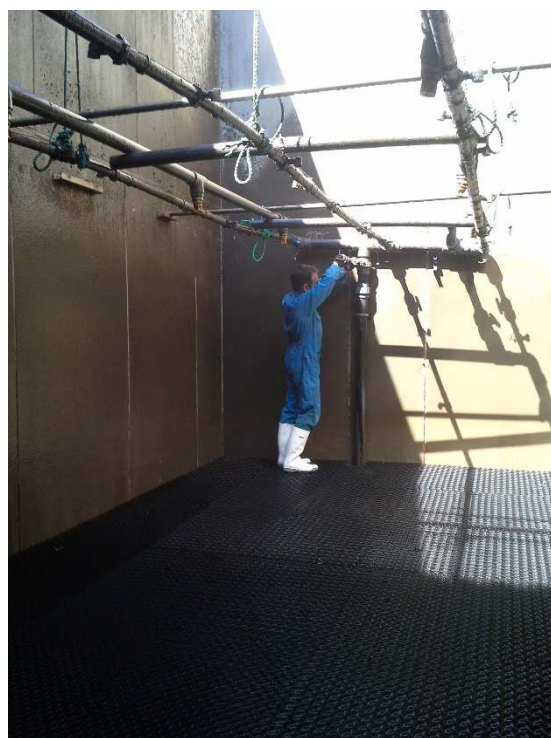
Elévation de la rampe d'arrosage suite à l'ajout d'une couche de maillage
